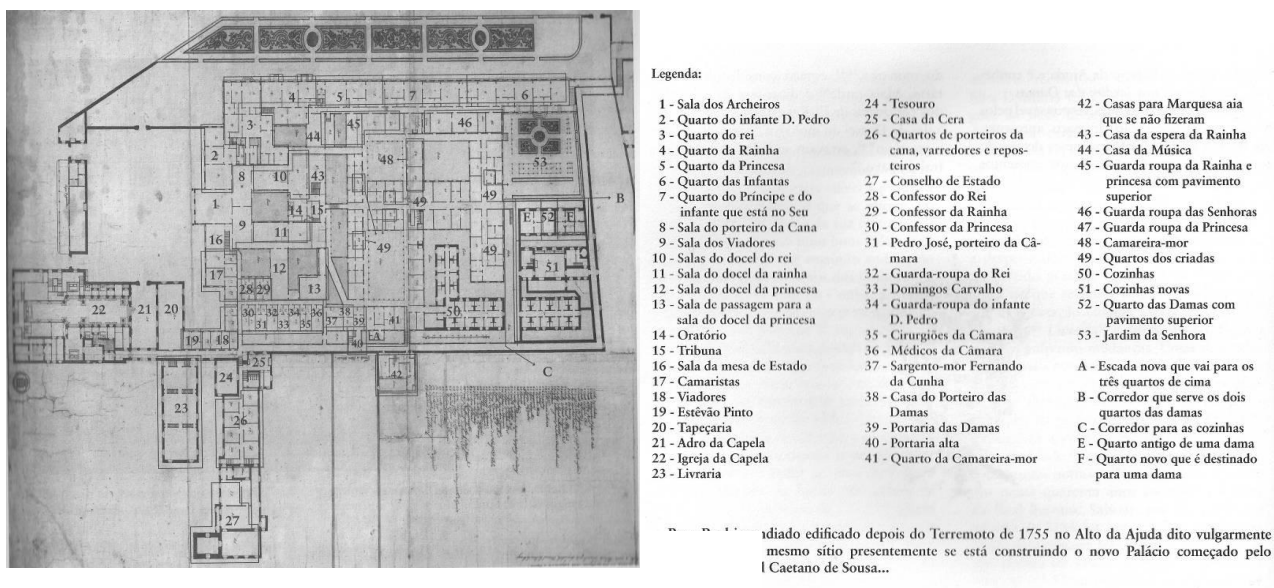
"Régia Barraca", planta e legenda dos espaços.
